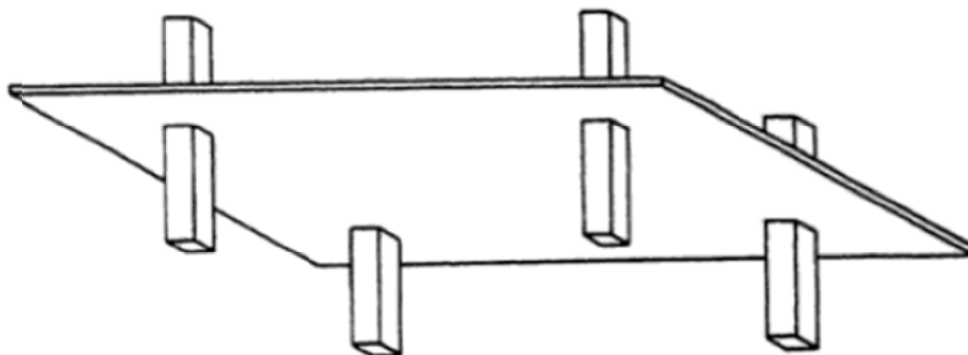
Laje lisa, *Reinforced Concrete Slabs* [10].
